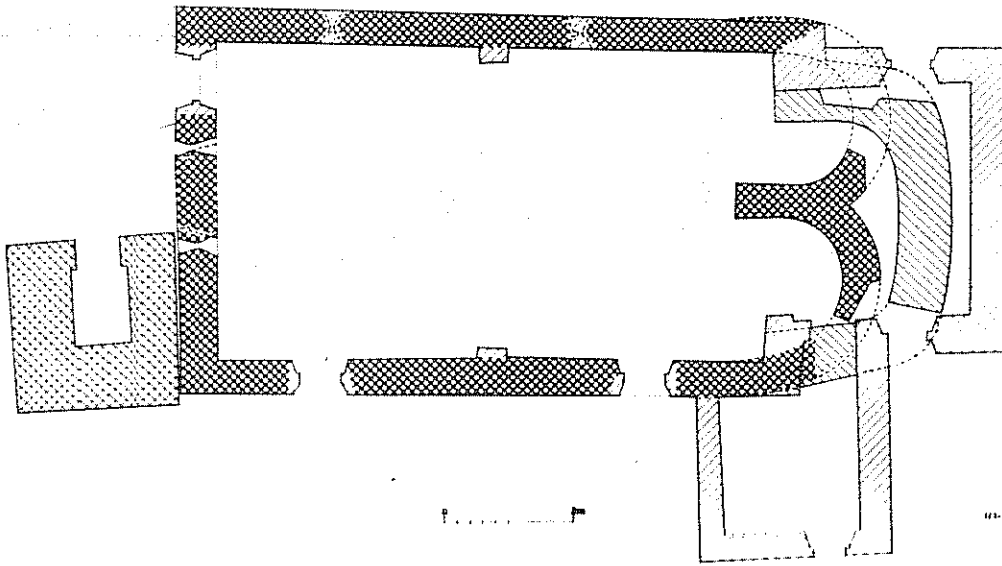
LUGAGGIA - Chiesa di San Pietro a Sureggio. Planimetria.
